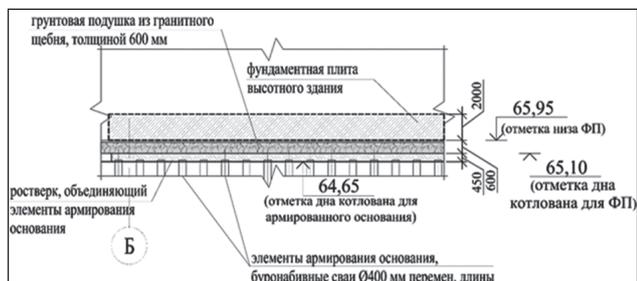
Техническое решение плитного фундамента на армированном основании для высотного здания в г. Сочи
